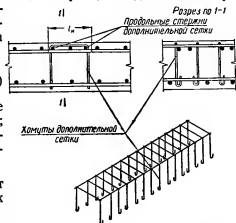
Дополнительные сварные сетки и хомуты, укладываемые в местах стыков основных сварных сеток.
